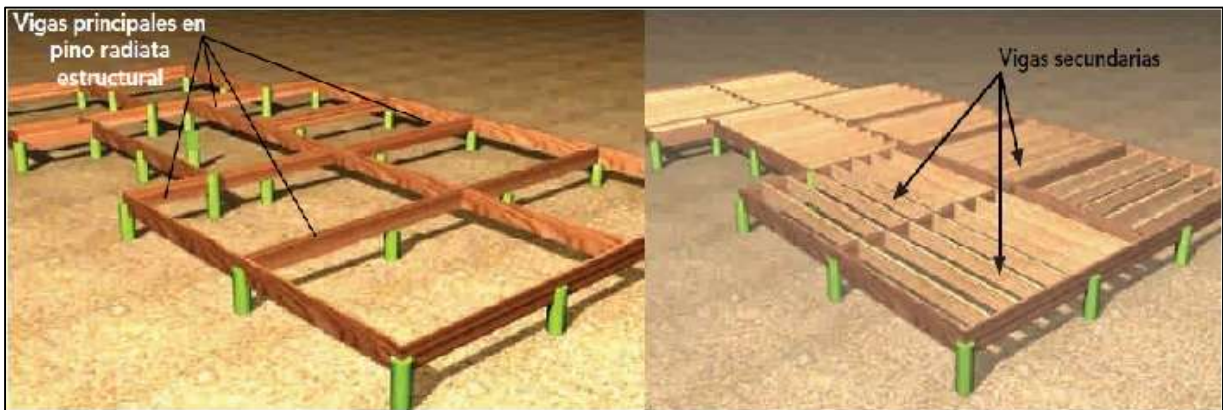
Vigas principales (izquierda) y vigas secundarias (derecha). (Fuente: La construcción de viviendas en madera. CORMA; 2013: 185, 187)
